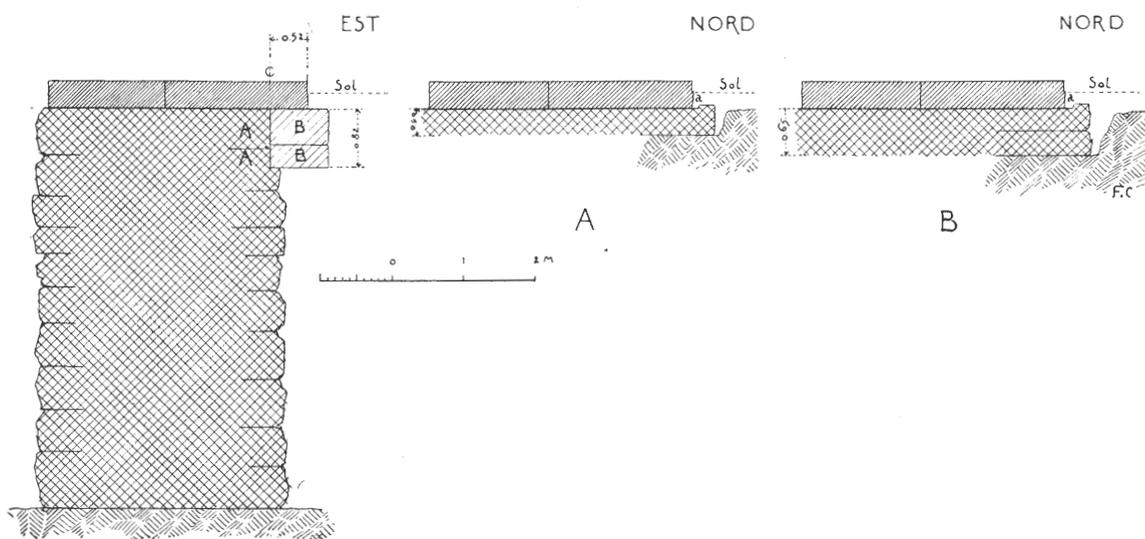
Coupe sur la fondation du côté Est (état actuel).
